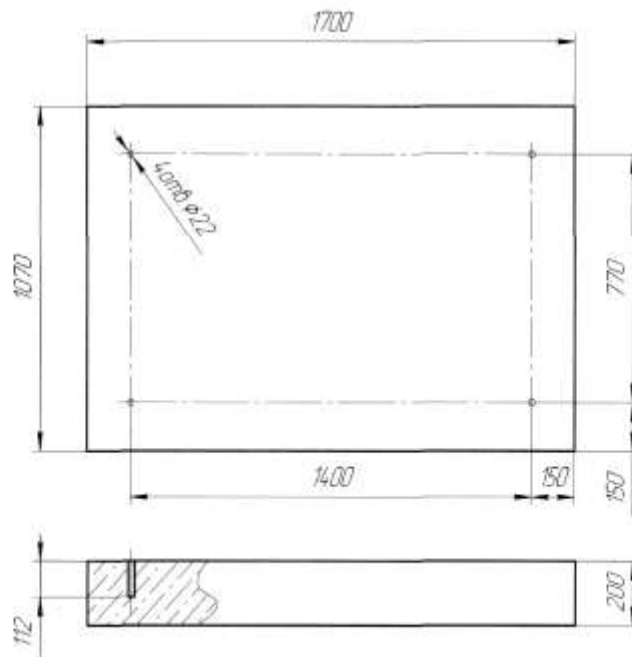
Окончательная схема фундаментной площадки куттера Л15-ФКМ
